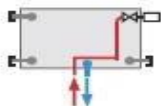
Detail připojovací armatury otopných trubkových těles Koralux ^[13]
